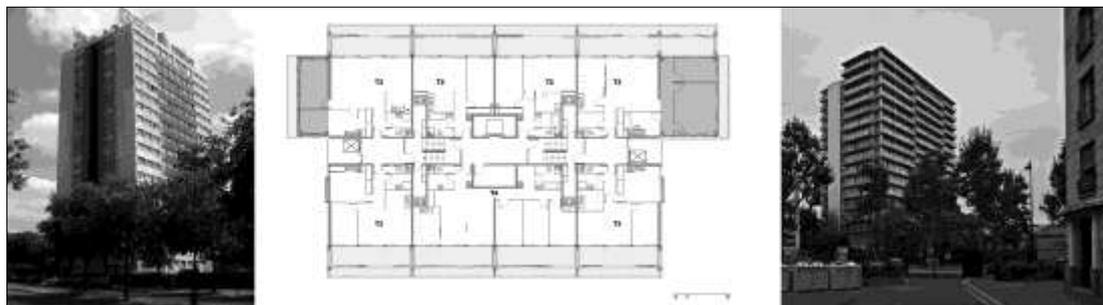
Druot, Lacaton y Vassal, *Proyecto Plus*, transformación de bloque de viviendas, París, 2011. El bloque inicial de viviendas espalda-espalda tenía 1800 cm de fondo y tras la transformación 2500 cm.
